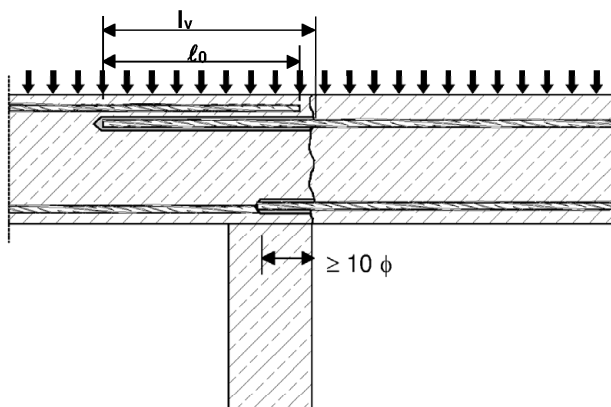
Übergreifungsstoß für Bewehrungsanschlüsse von Platten und Balken
